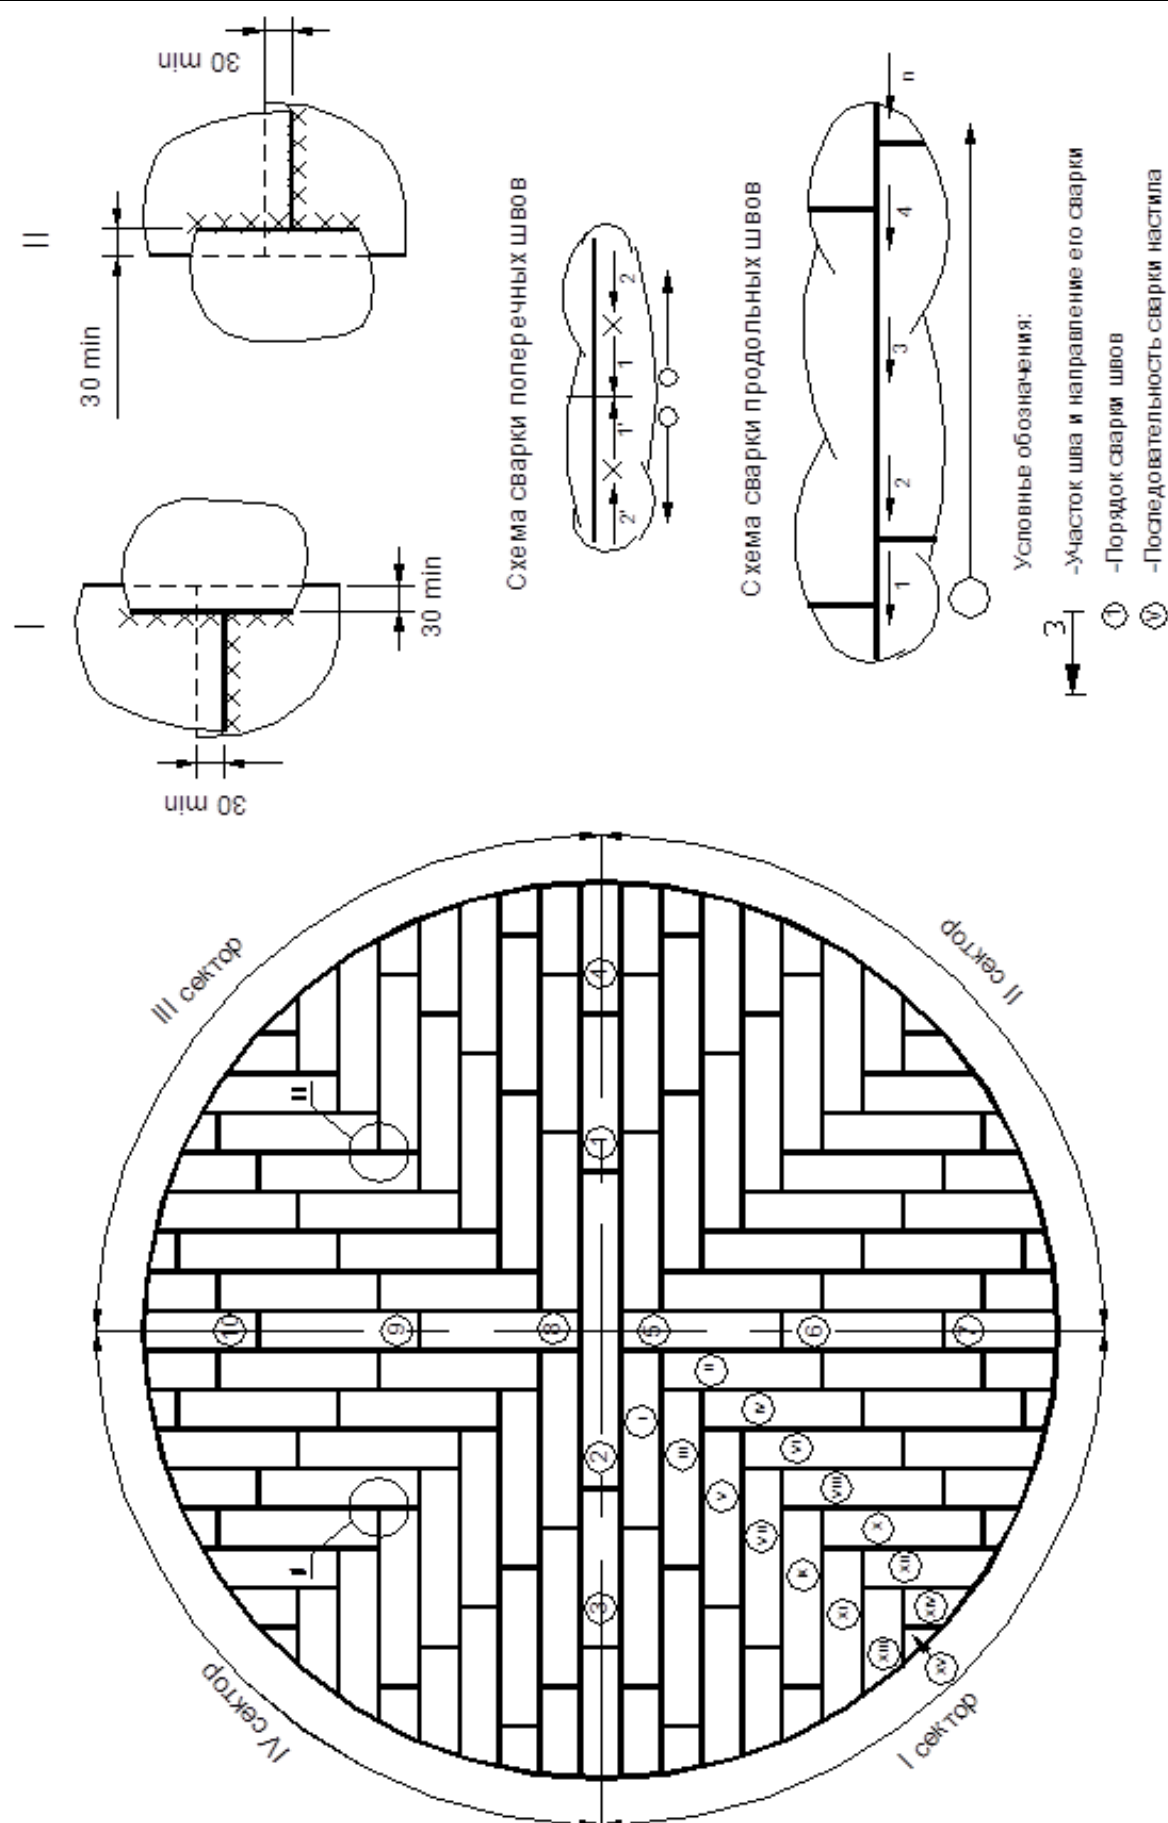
Последовательность и схема сварки настила крыши
